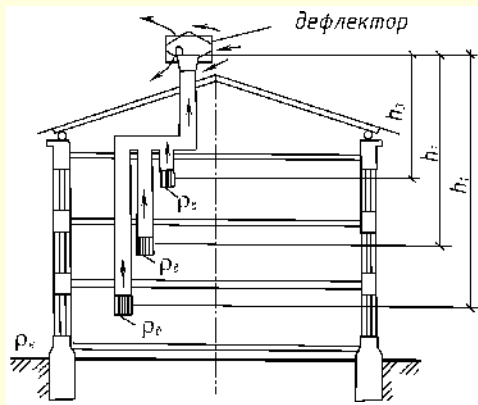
Схема вытяжной естественной канальной вентиляции
